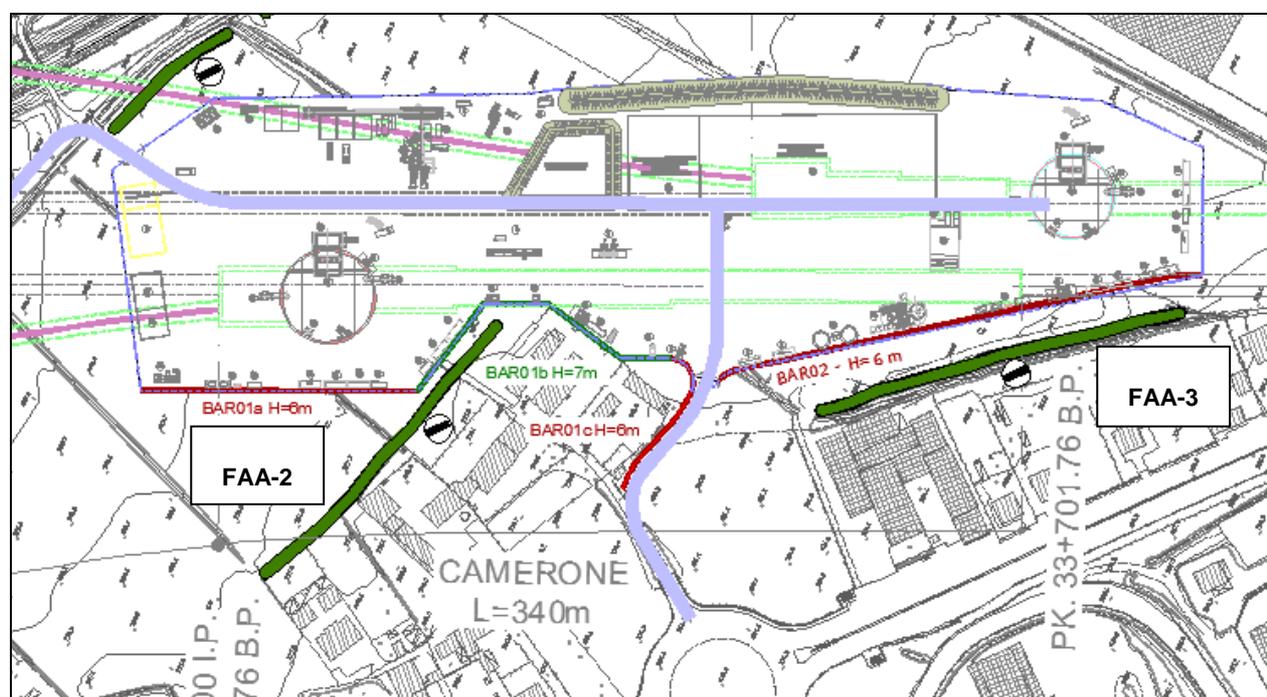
Stralcio planimetrico con la localizzazione delle fasce di vegetazione lungo il margine del cantiere COP6
